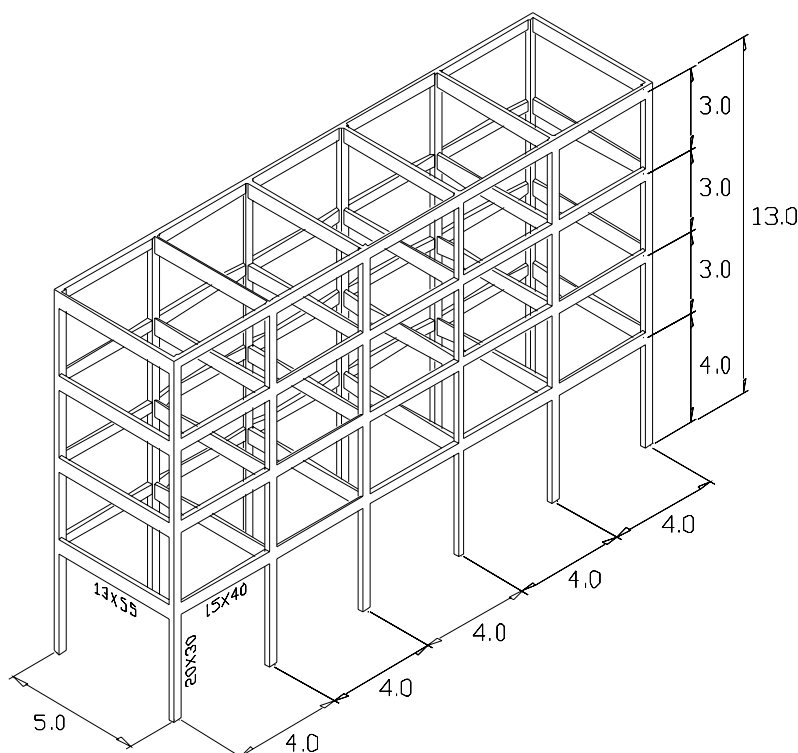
Pórtico espacial (dimensões do pórtico em metros e das seções transversais em centímetros)
